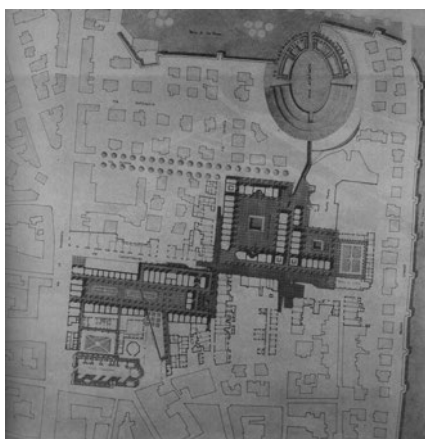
Planimetria generale del progetto di riqualificazione dell'area San Francesco.
